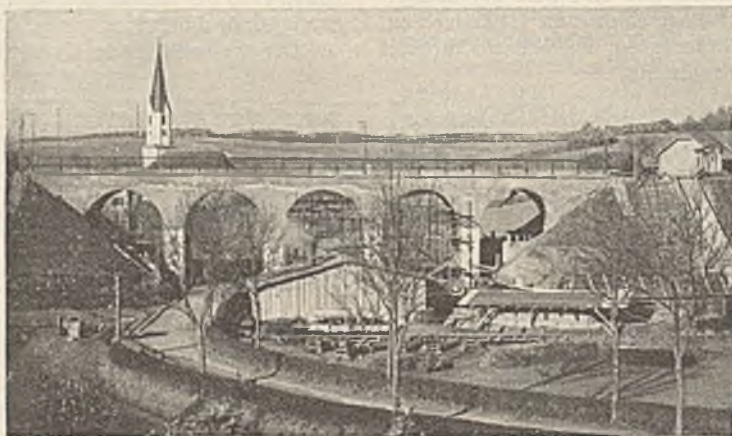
Viadukt Kläham. Alter Viadukt mit Baustelleneinrichtung.
